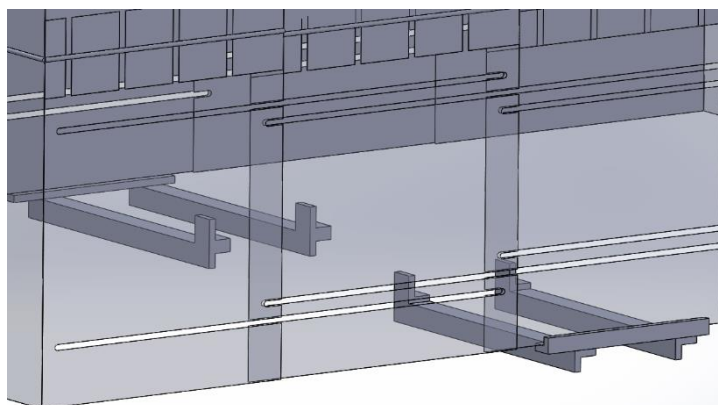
Estructuras soporte de los puntos de apoyo laterales de la cubierta
